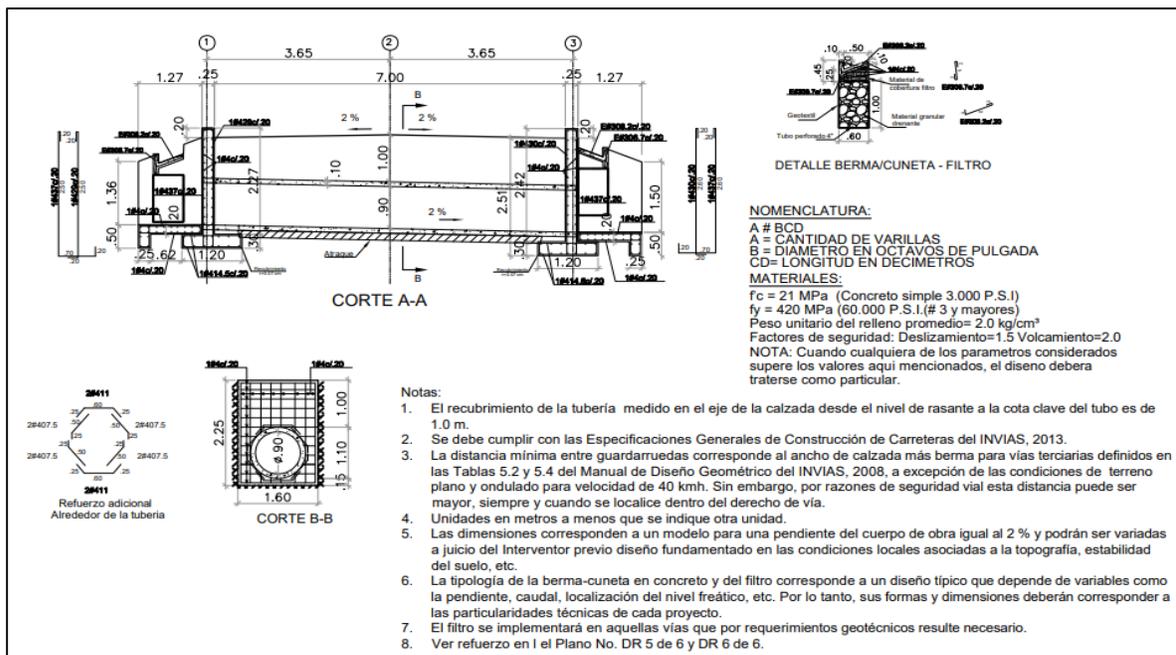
Detalle refuerzo Alcantarilla con muros en concreto reforzado Aleta – Aleta.
